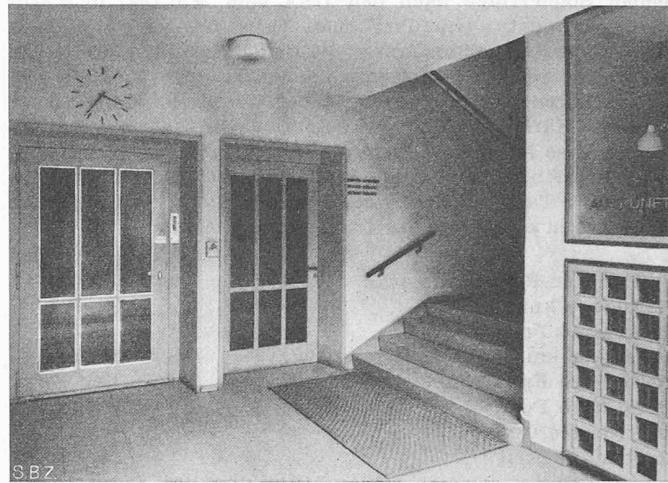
Eingangs-Vorplatz im Erdgeschoss; links Türe zum Bettenlift
